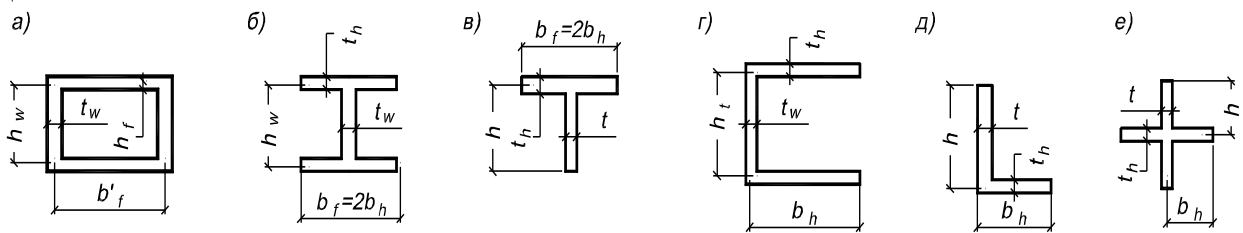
Схемы расчетных сечений элементов, не подкрепленных ребрами жесткости
